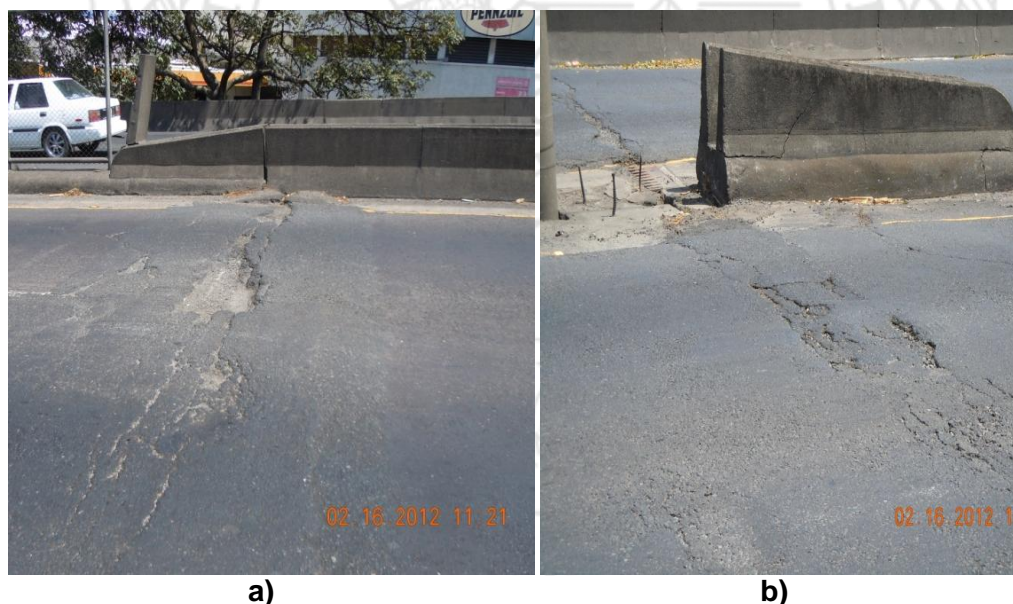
Estado de las juntas de expansión del puente izquierdo (sentido Alajuela-San José) (a) bastión Sur y (b) bastión Norte
